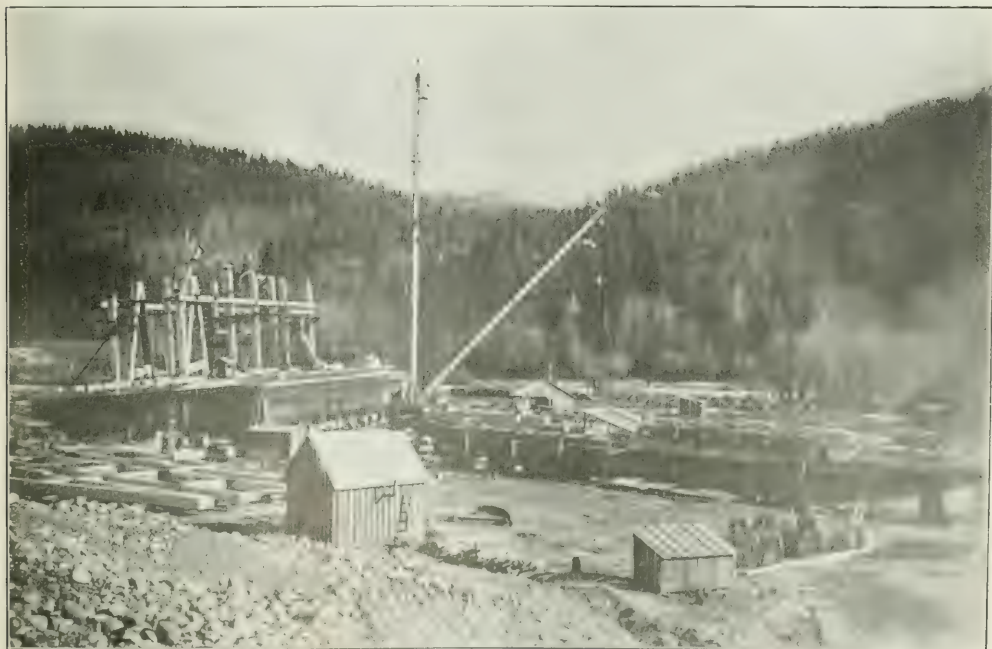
CONSTRUCCION DE LA DRAGA ESTABROOK
